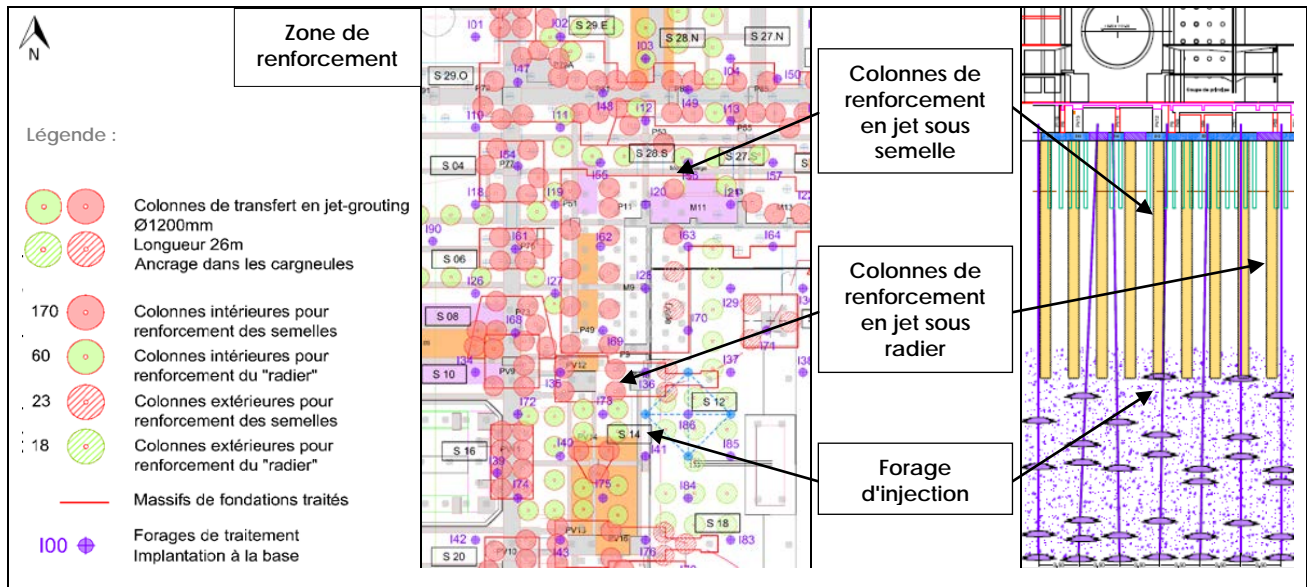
Vue en plan des fondations existantes et de la solution de confortement retenue
